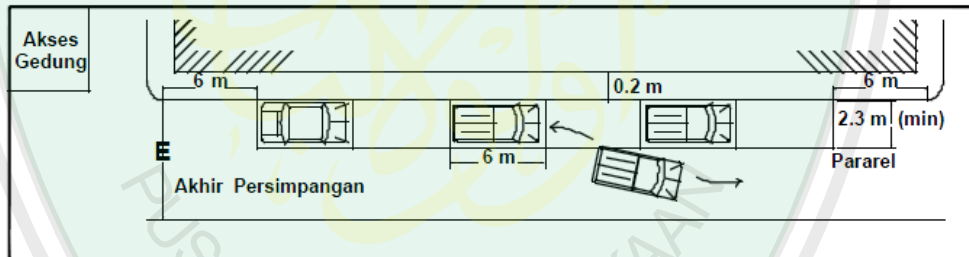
Kebutuhan Ruang Jalur Kendaraan
